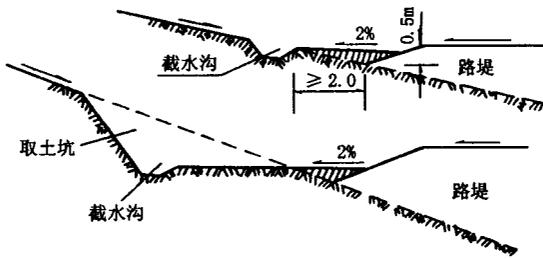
山坡路堤上方截水沟(尺寸单位:m)
